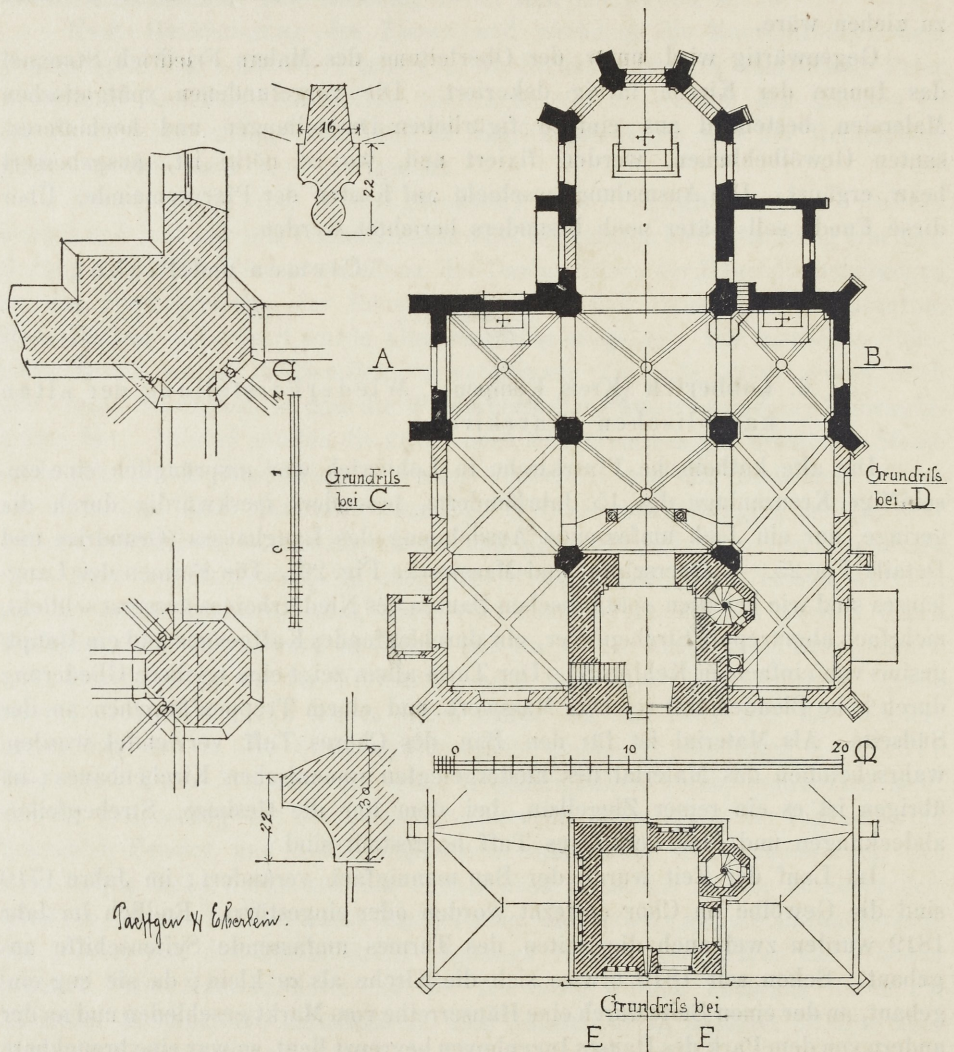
Lobberich. Grundriss und Details der alten kath. Pfarrkirche.
